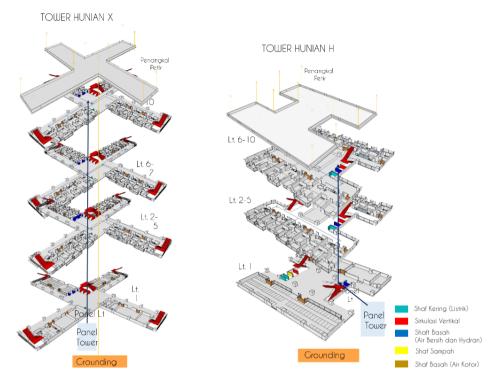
Utilitas dalam Site (Sumber: Dok. Pribadi)
